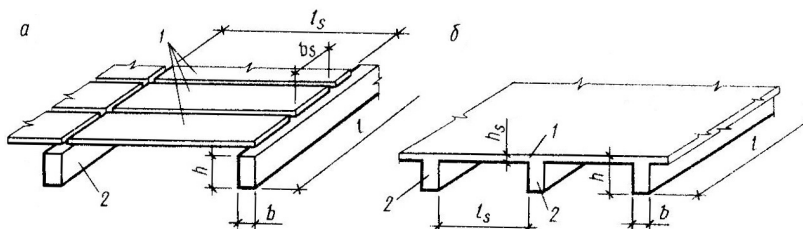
Изгибаемые железобетонные элементы: а – сборное перекрытие; б – монолитное перекрытие; 1 – плиты; 2 – балки
